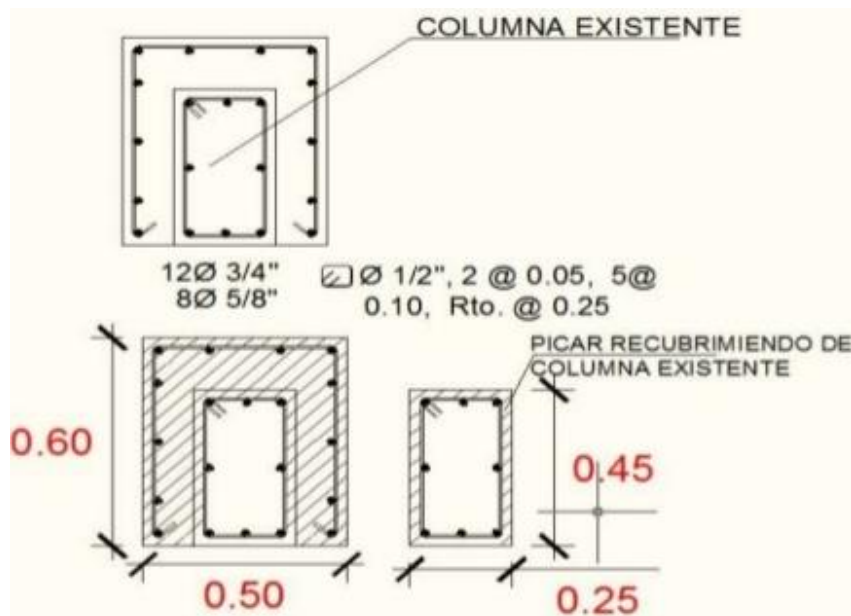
Procedimiento típico para el reforzamiento de columnas de concreto armado mediante el encamisado de columnas. Fuente: Retrofitting Design of Building Structures, Xilin Lu (2010).
